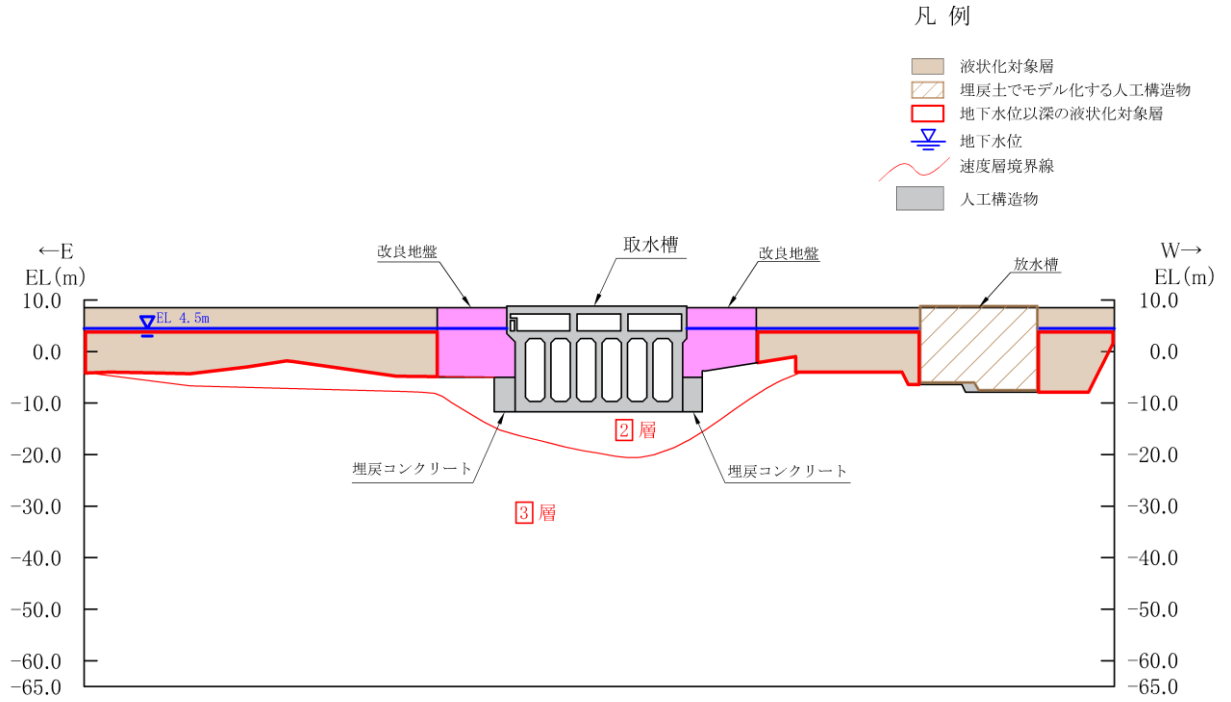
取水槽 地震時荷重算出断面図 (A-A 断面位置)
